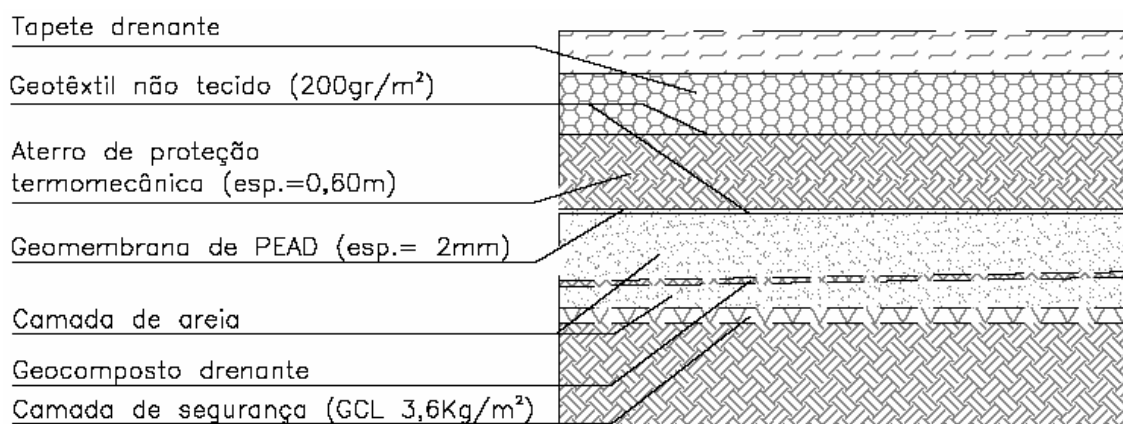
Sistema de impermeabilização de base (liner) para o Aterro Sanitário de Limeira-SP
